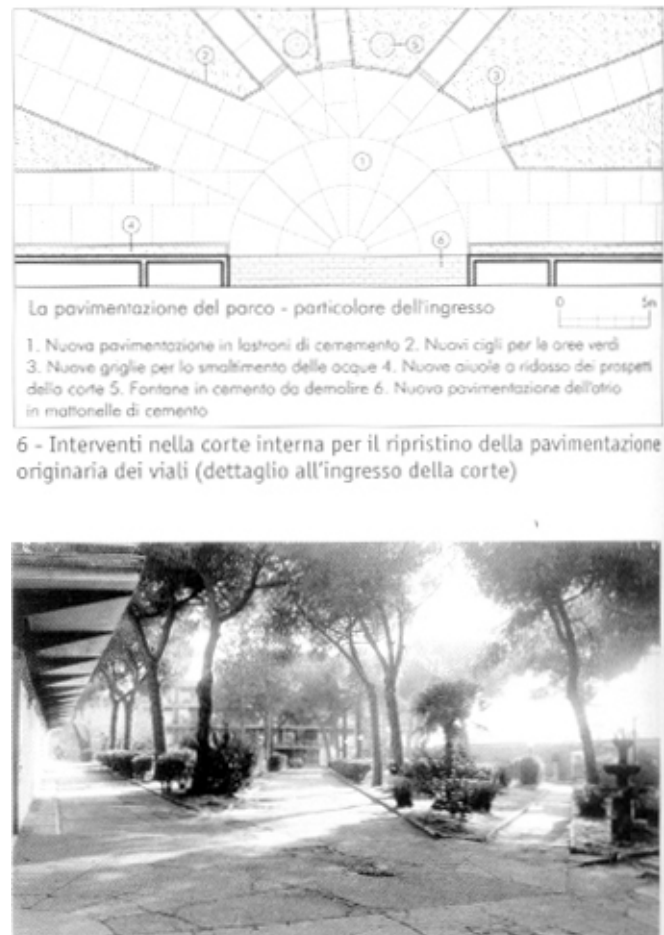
Proposta de intervenção na pavimentação original da área comum do complexo Tuscolano III.
